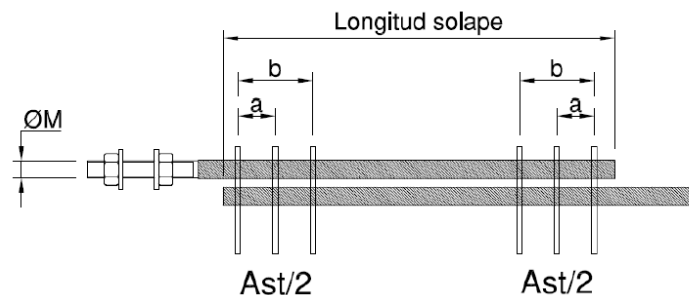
Longitud de solape i cotas para la armadura transversal
